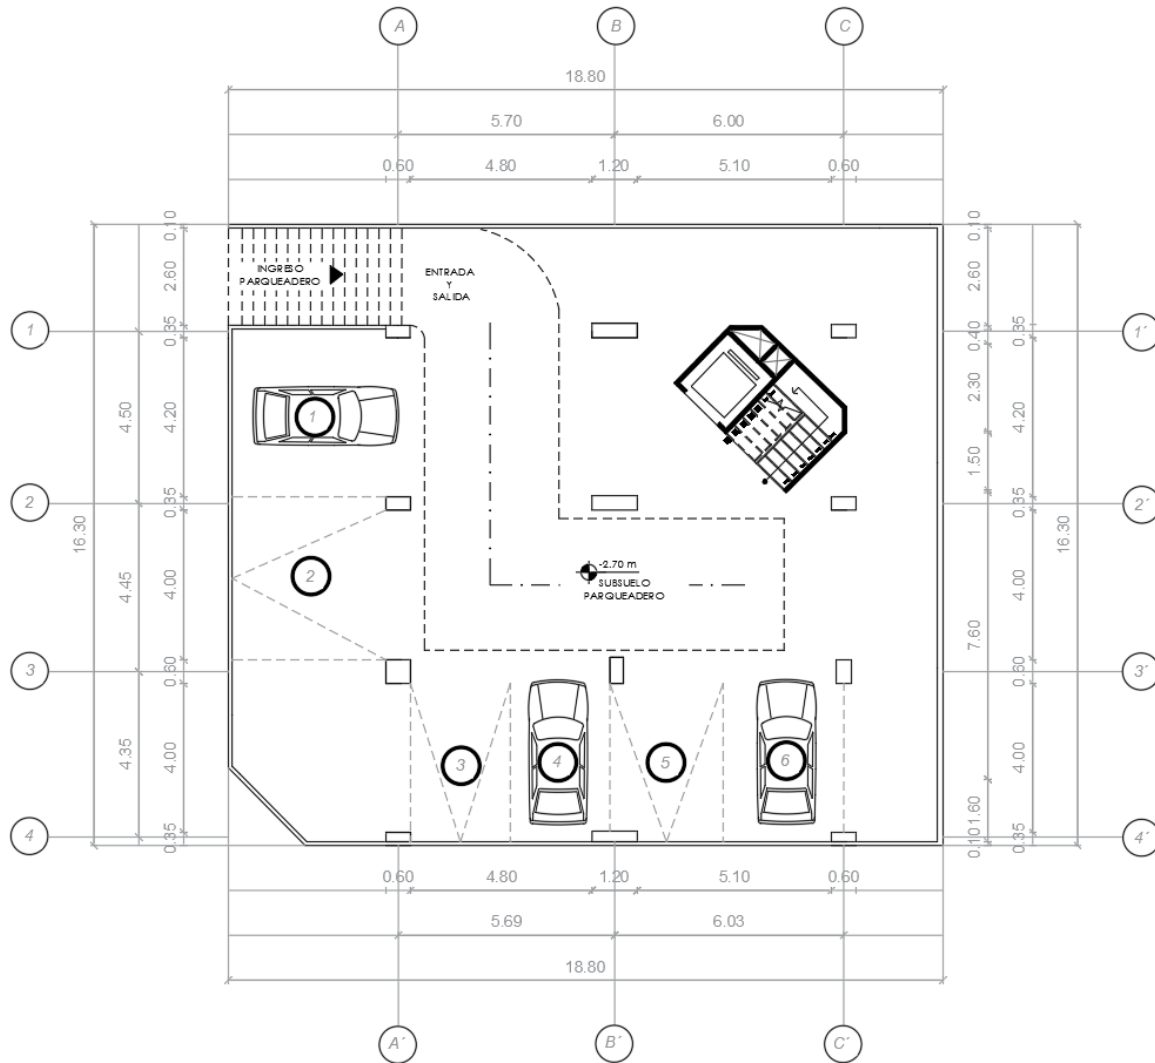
ESTOA edificio "El Ejecutivo". Planta de subsuelo, garaje.
